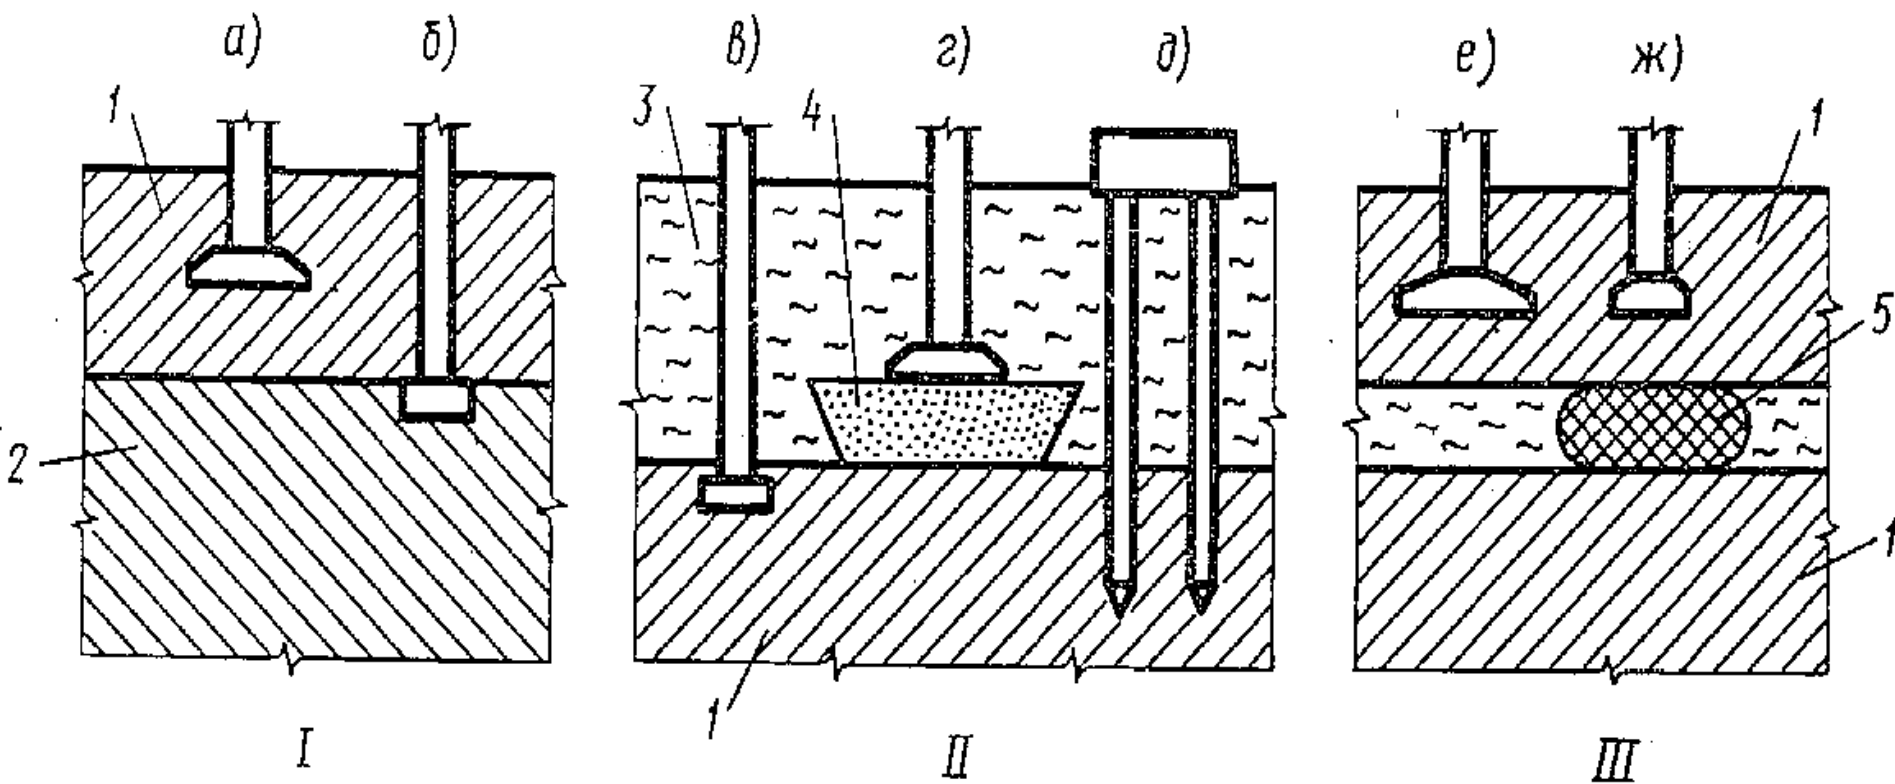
Схемы напластований грунтов с вариантами устройства фундаментов:
